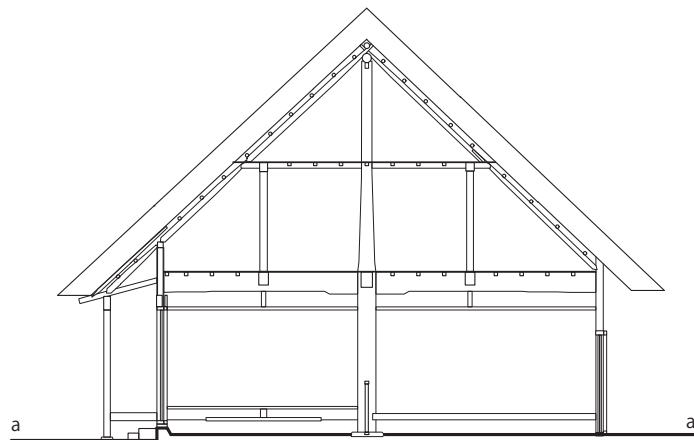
今井秀郎家住宅 梁行断面図 1/150
